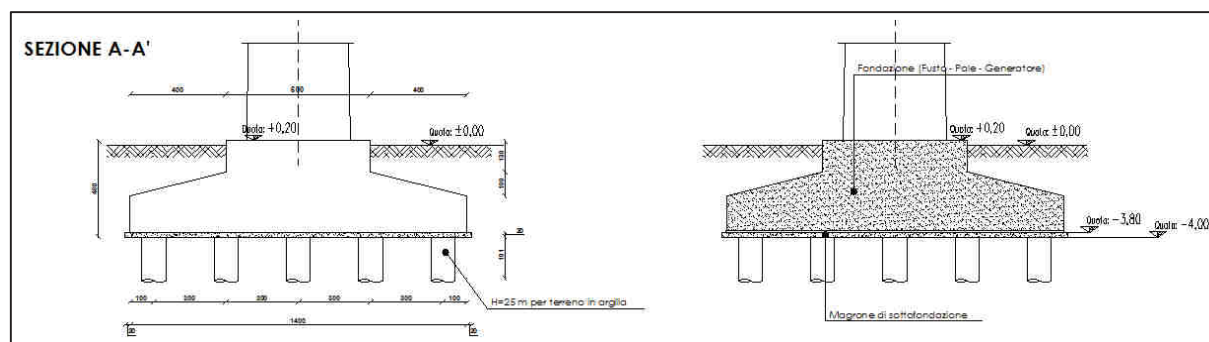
Sezione tipo fondazione degli aerogeneratori.
